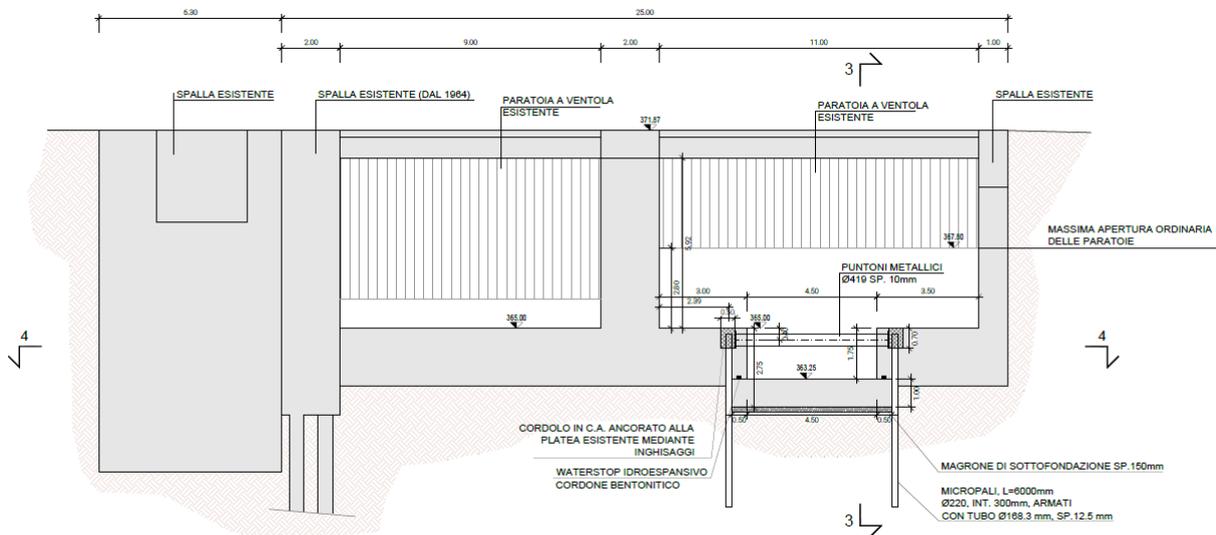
Sezione di intervento di adeguamento della traversa esistente nel PE
